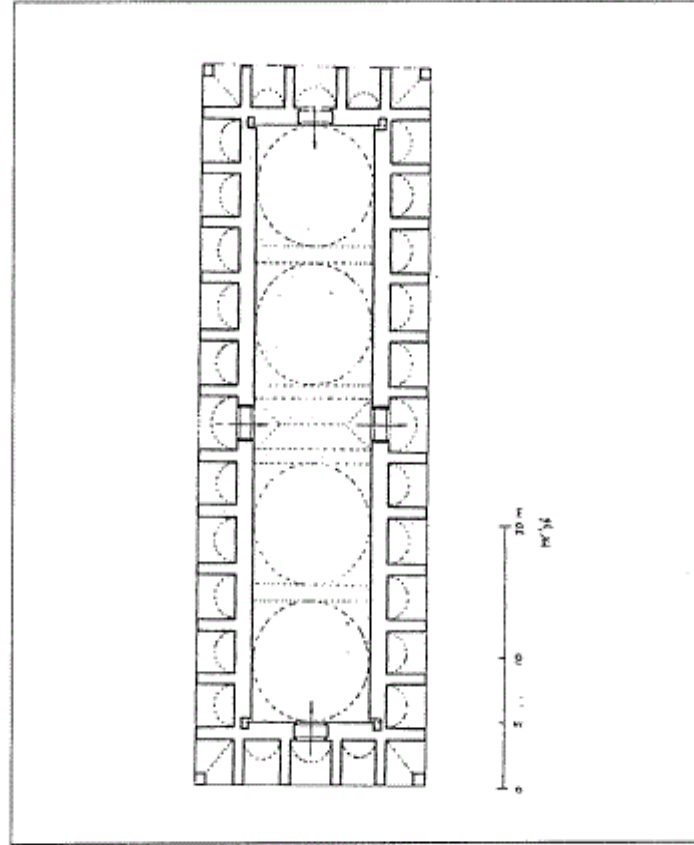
مسقط أفقي لبادستان سيريز باليونان (عن : Cezar) .
